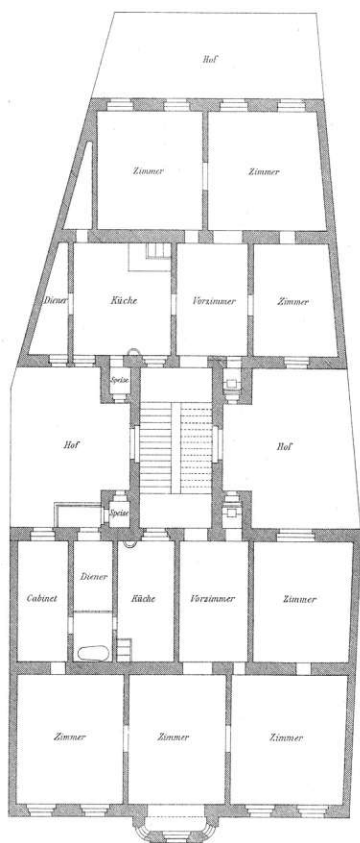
Grundriss Mezzanin, 1. und 2. Obergeschoss, Alleegasse 69 - Ignaz Sowinski, 1891
